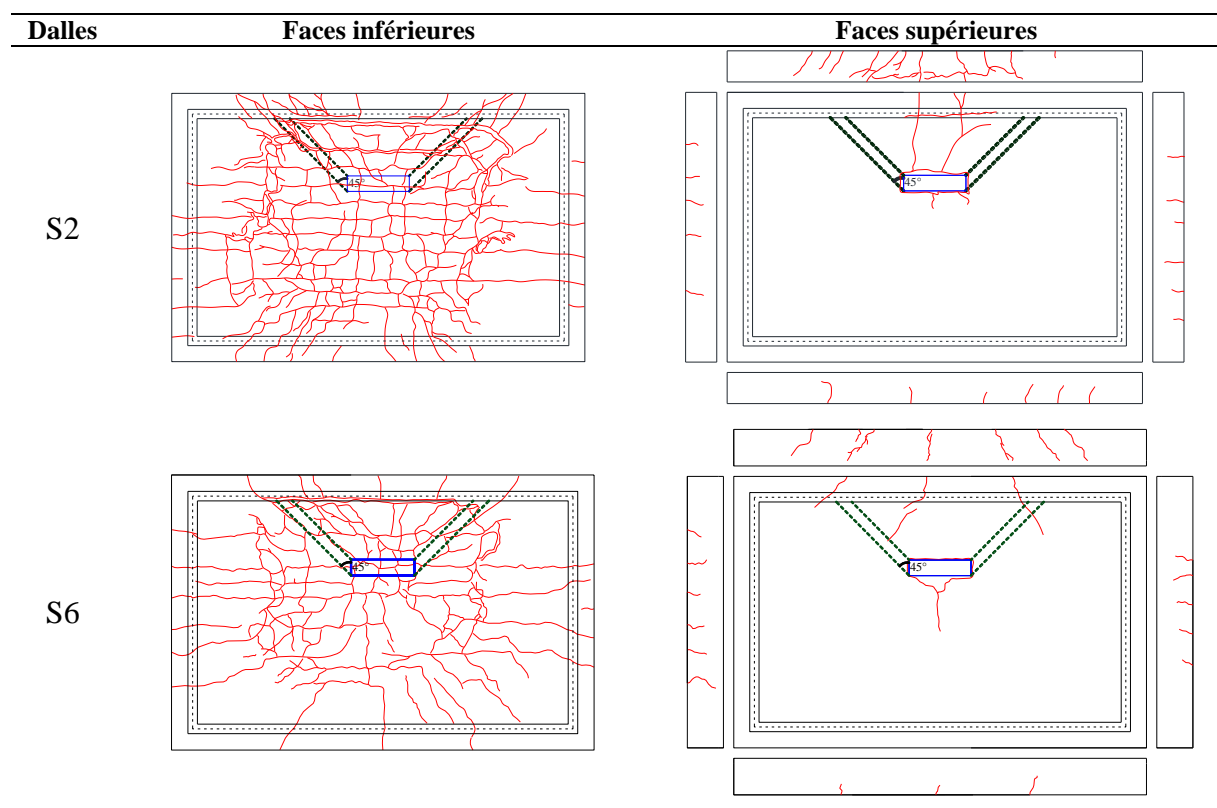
Schémas de fissuration des dalles S2 et S6 : Série II
